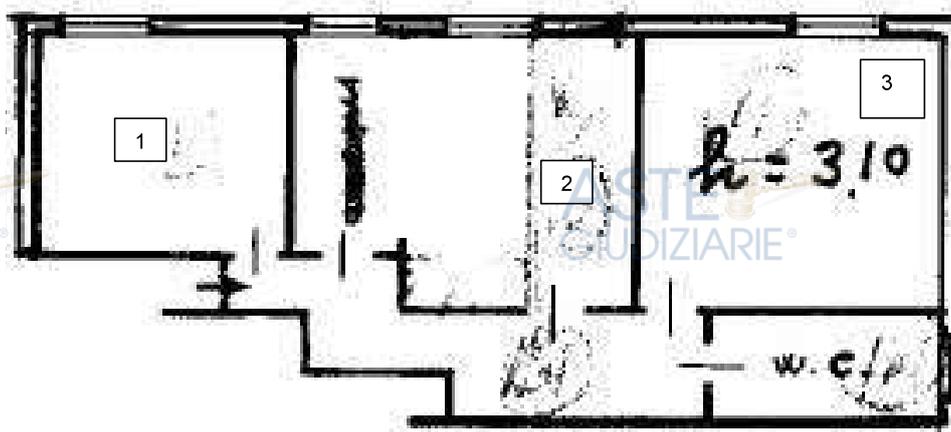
Schema planimetria stato dei luoghi immobile 10
